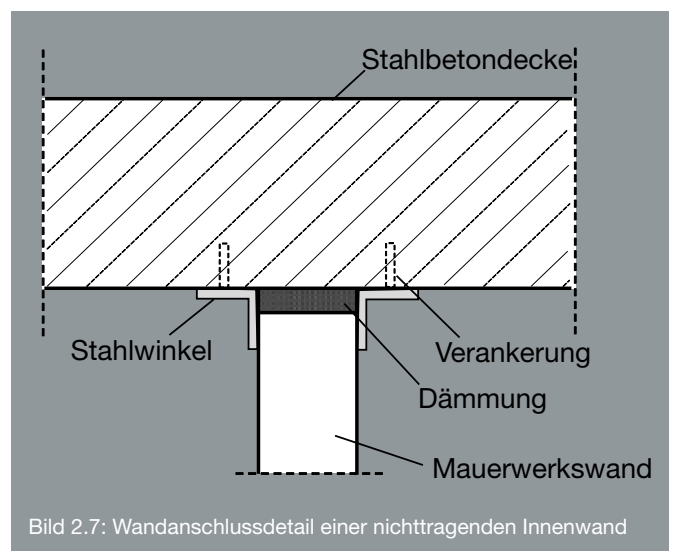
Wandanschlussdetail einer nichttragenden Innenwand
